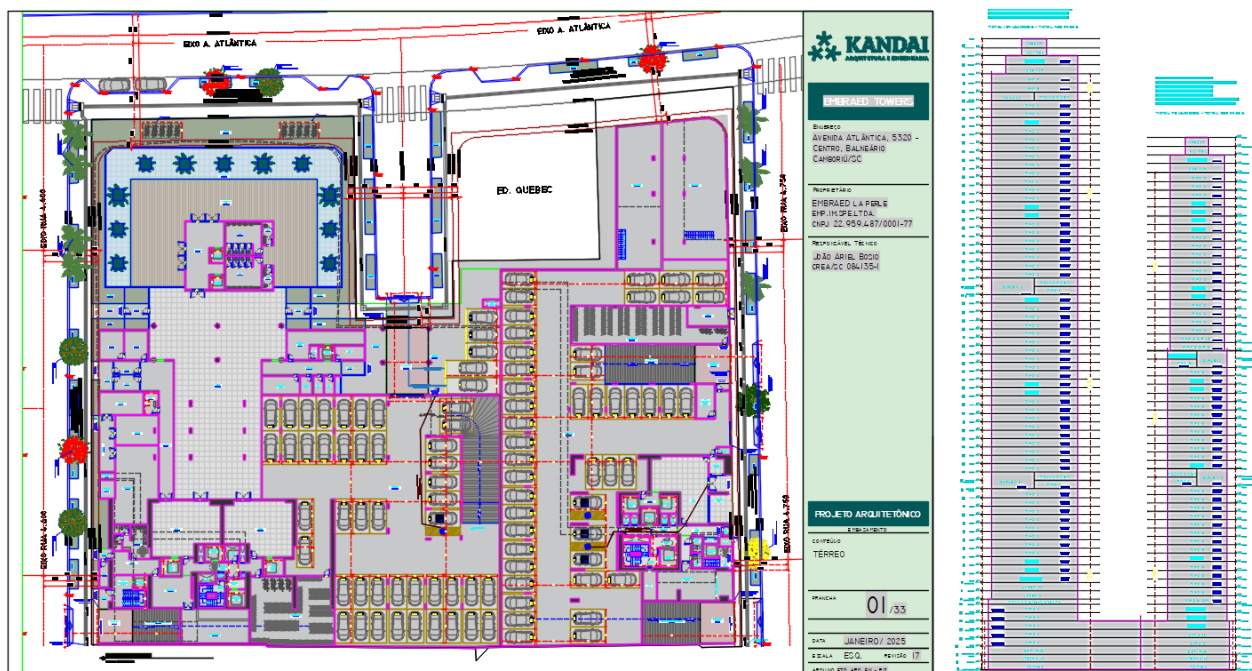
Desenho em planta e corte esquemático do empreendimento (Kandai, 2025).
